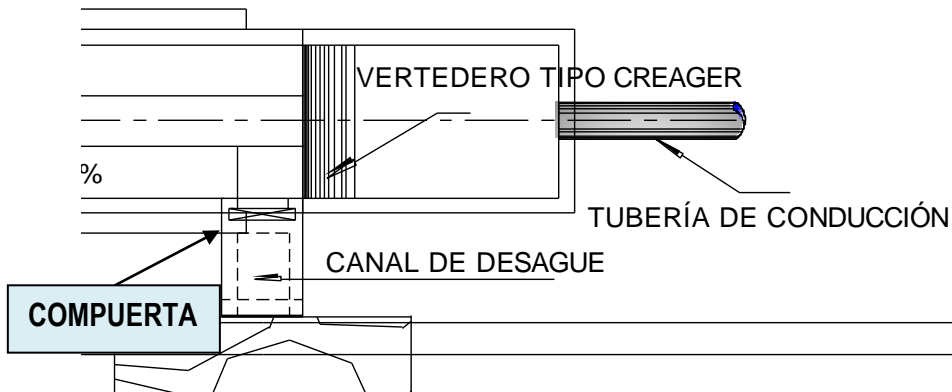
Vista en planta de la compuerta del desarenador (Elaborado por Herrera Diego)
